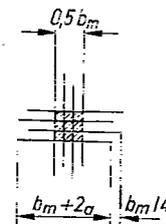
Zusätzliche Bewehrung unter einer Einzellast
